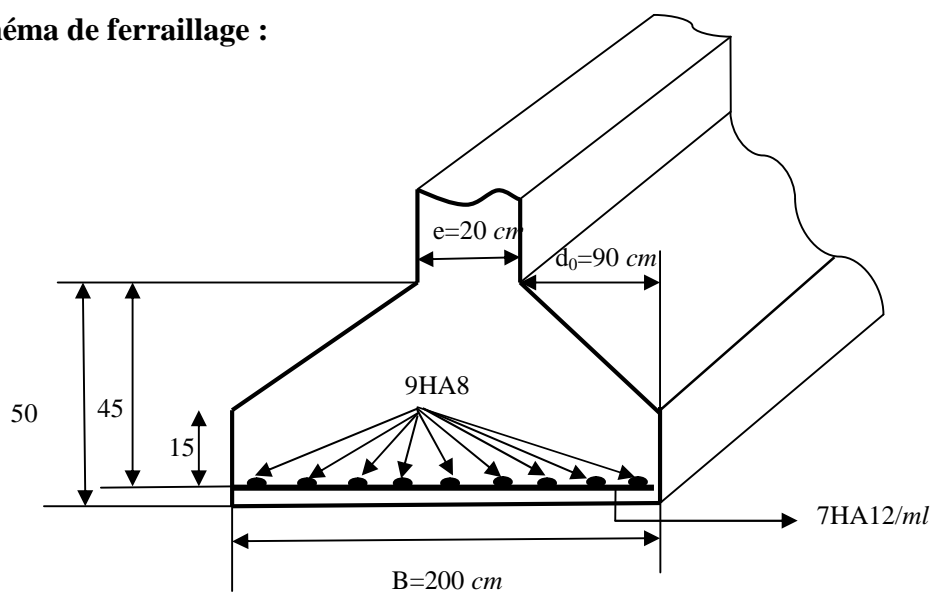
Schéma de ferrailage de la semelle filante sous voiles
